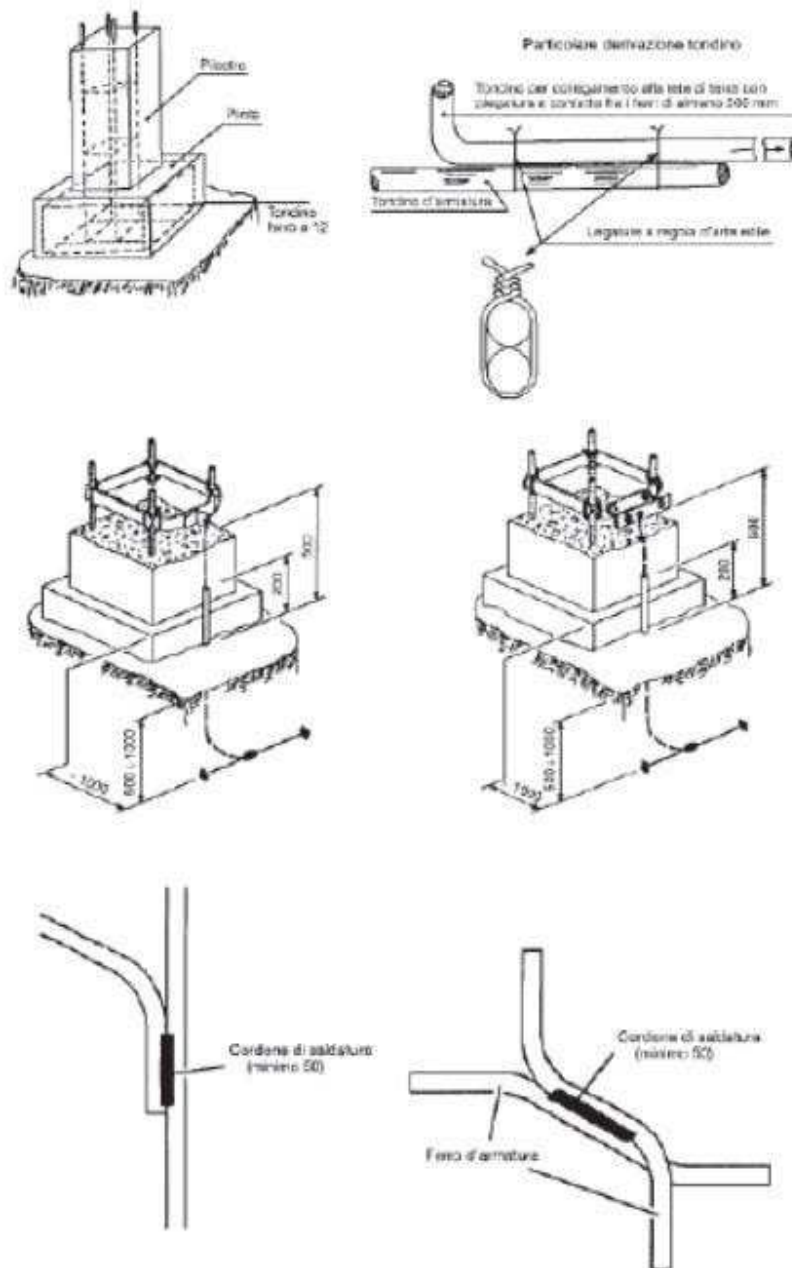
Esempi di plinti di pilastri e di connessioni ai ferri dell'armatura (dimensioni espresse in mm)
